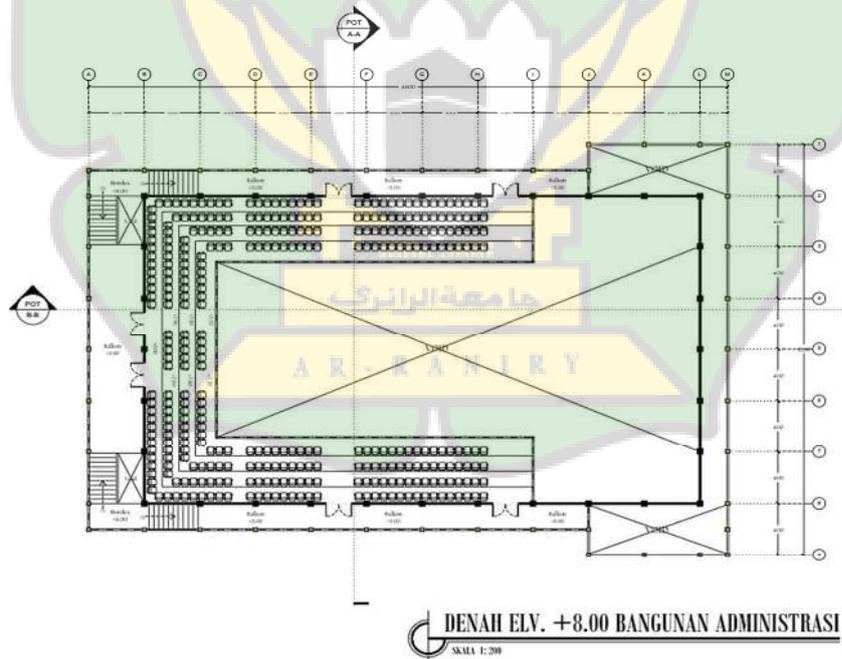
33 Denah Adinistrasi dan Aula Lantai 1
